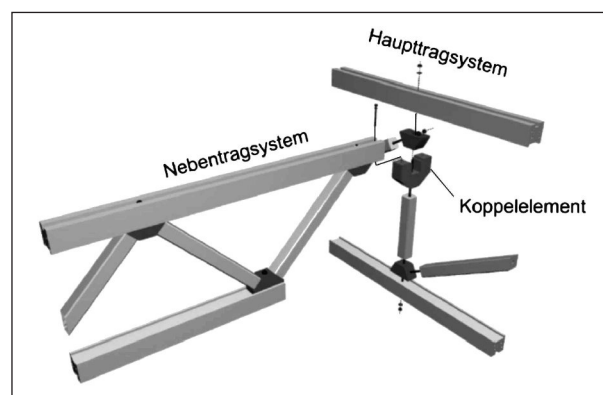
Konstruktionsprinzip der modularen Fachwerkkonstruktion (HENZE, 2009)
